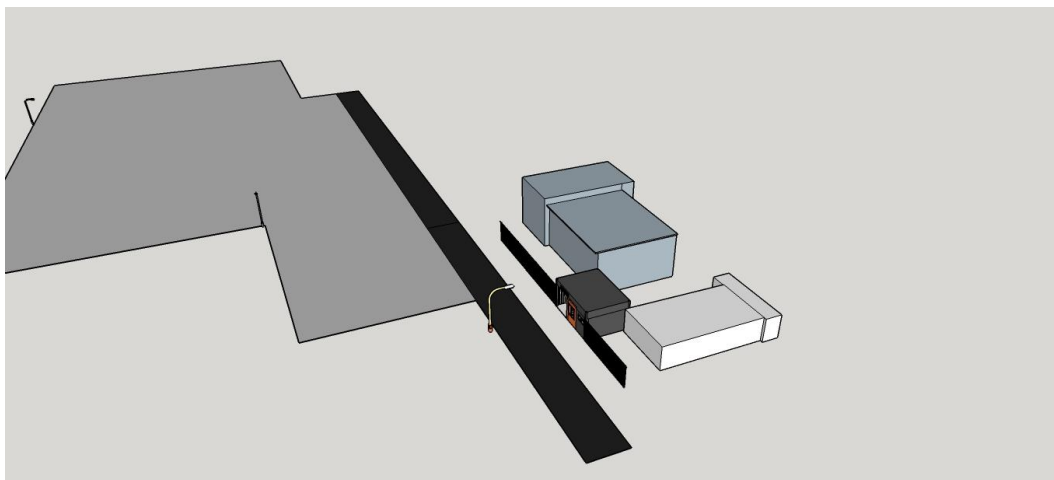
Skutečný pohled na vrátnici směr sever
